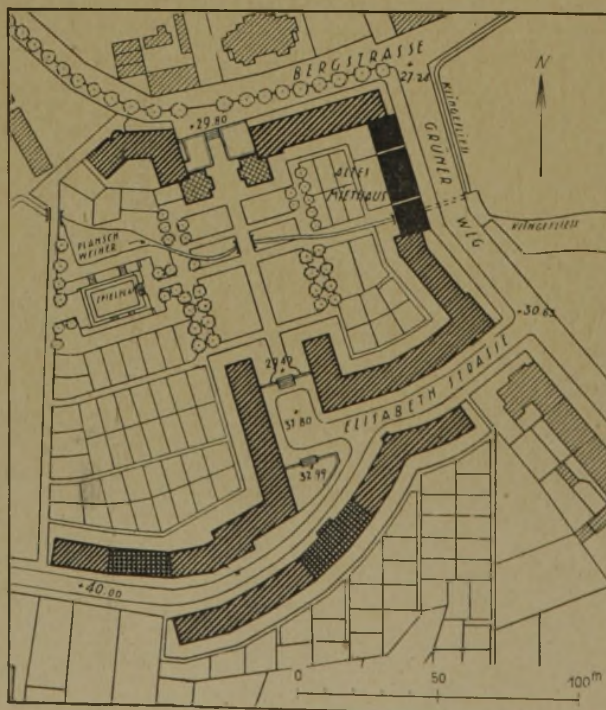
Lageplan Baugruppe am Grünen Weg.
